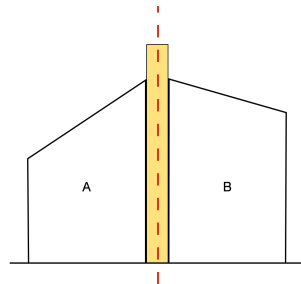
Schéma d'un mur mitoyen (en jaune) soutenant deux immeubles, A et B, de même hauteur
